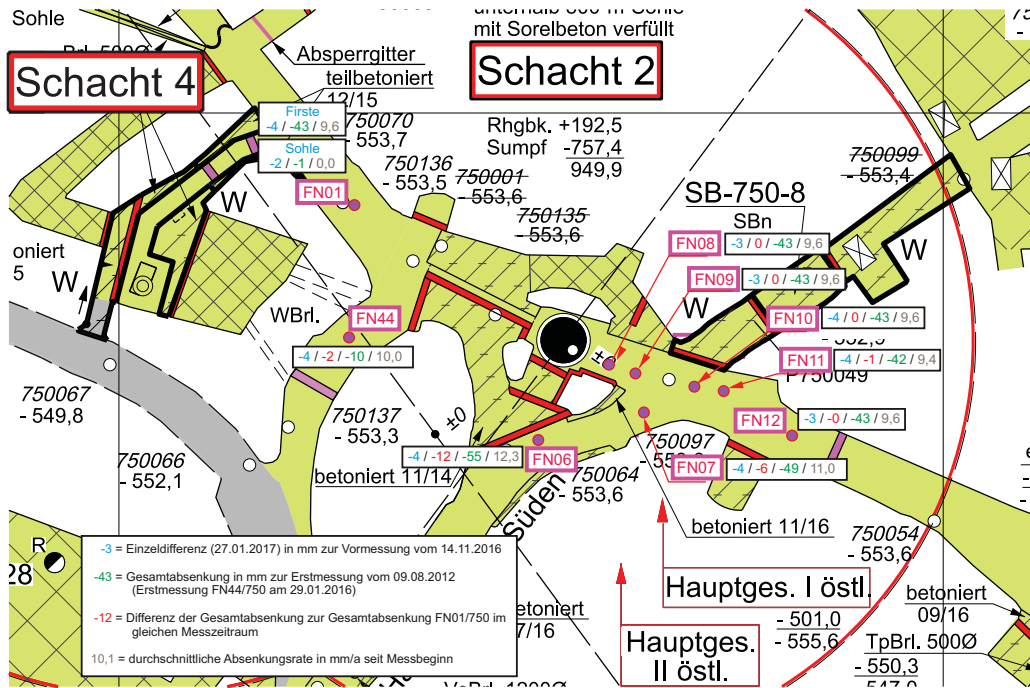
Grundrissausschnitt 750-m-S mit Lage / Senkungsdifferenzen der Firstnivellierungspunkte
